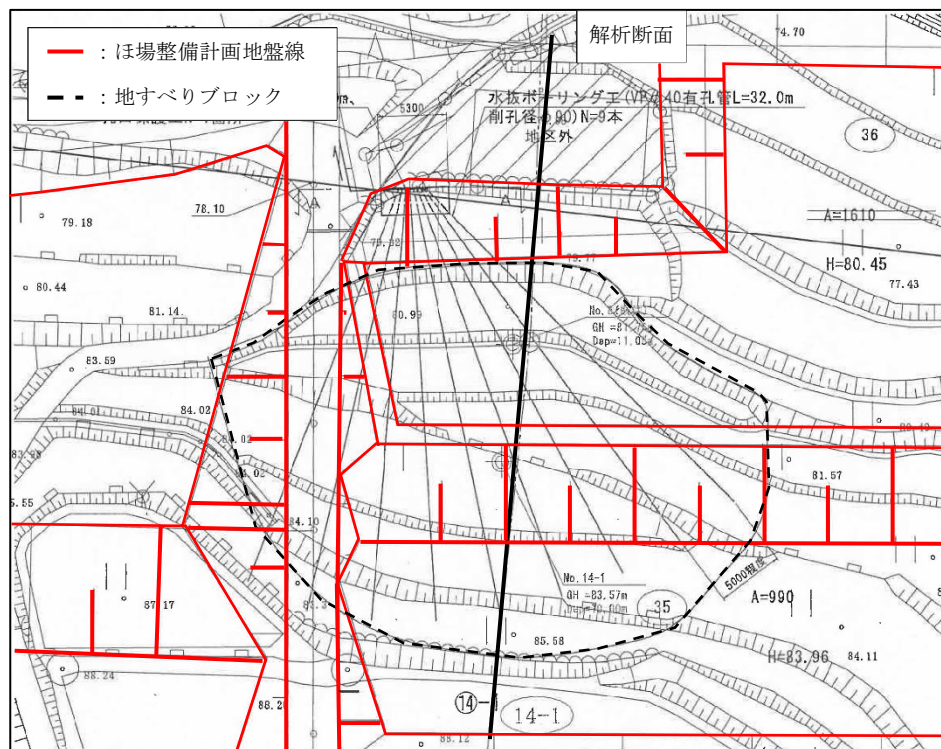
生田大坪地区14-1ブロック 対策工計画平面図
